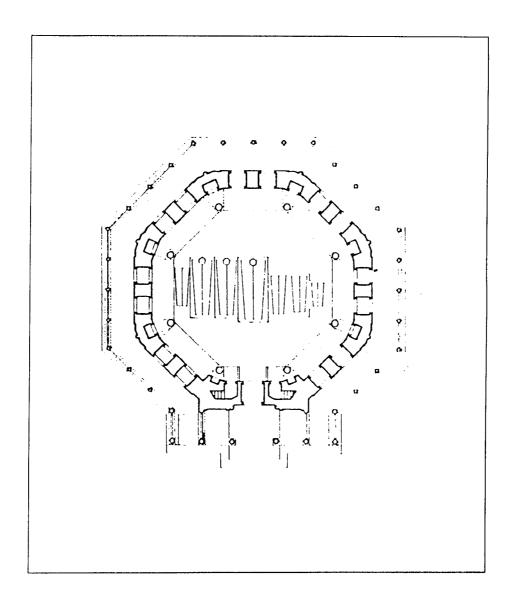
مسقط أفقي لتربة سليم الثاني في مدافن أيا صوفيا بإستانبول (عن : اصلان ابا) .
